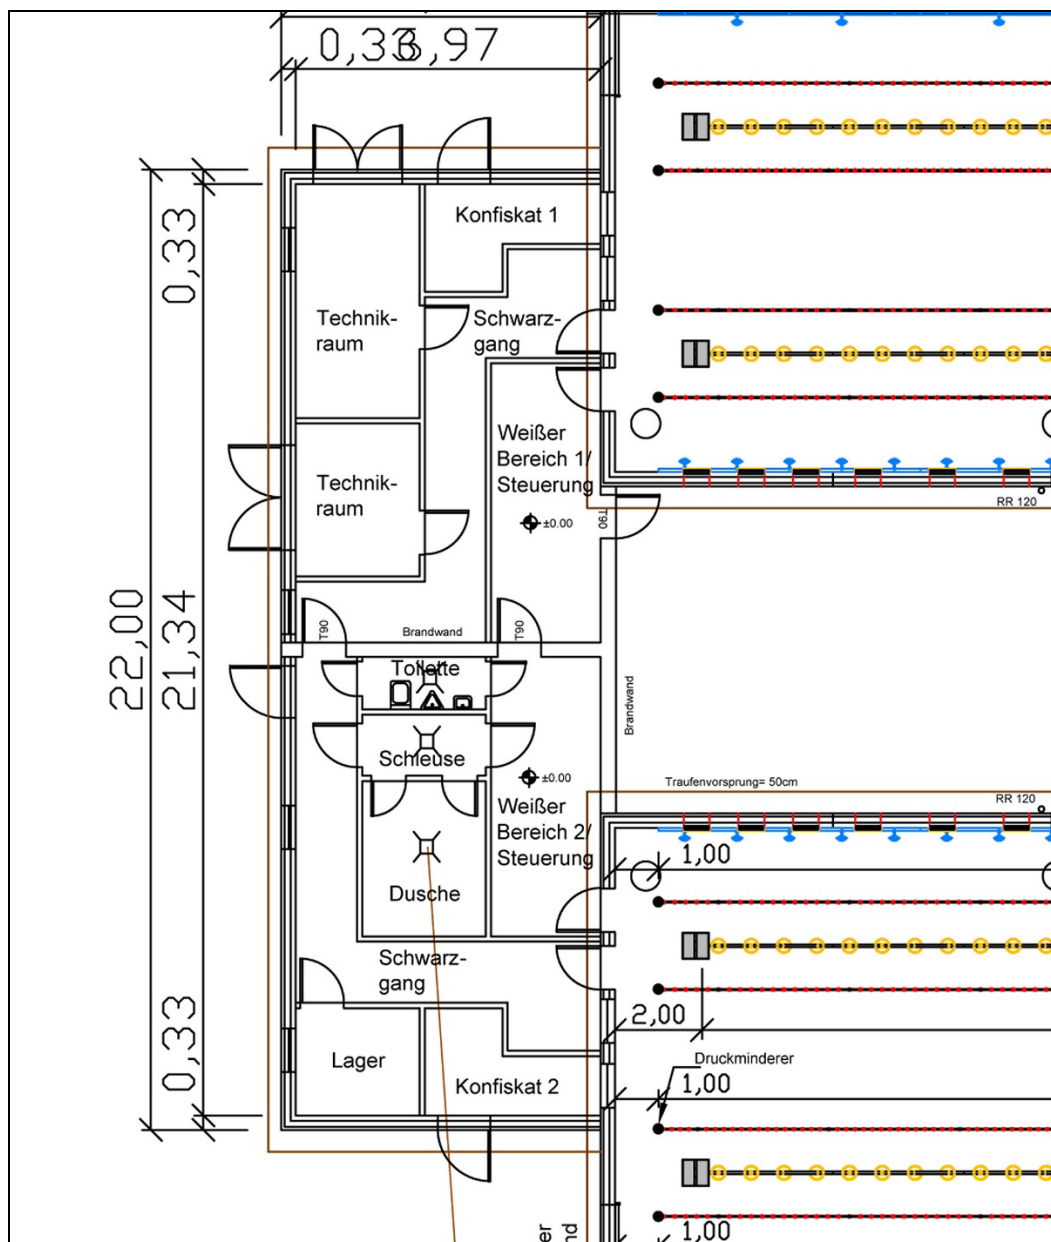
Grundriss mit Darstellung der Stallnebenräume der geplanten MHS_4 und 5
